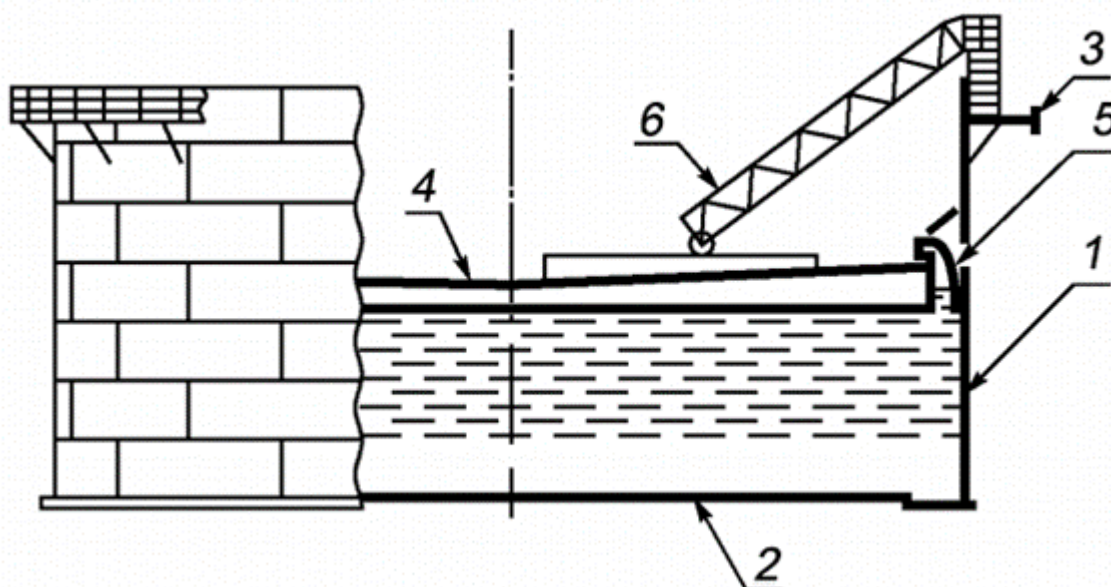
Основные конструктивные элементы РВСПК: 1 — стенка; 2 — днище; 3 — ветровое кольцо; 4 — плавающая крыша; 5 — уплотняющий затвор с погодозащитным козырьком; 6 — катушечная лестница
